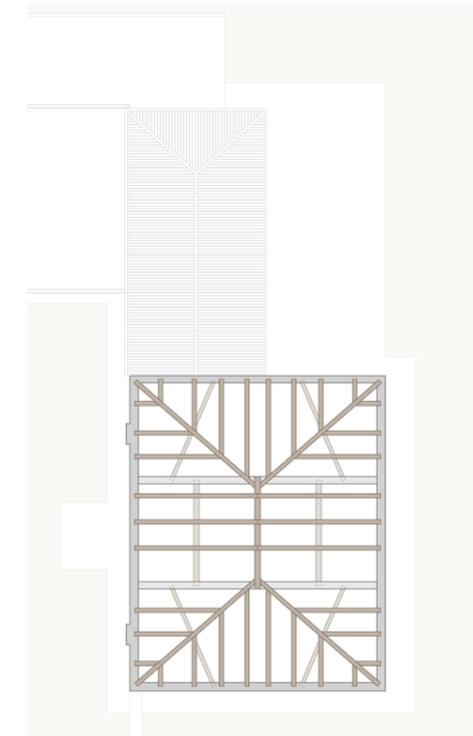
Pianta piano tetto, rilievo costruttivo, fuori scala
